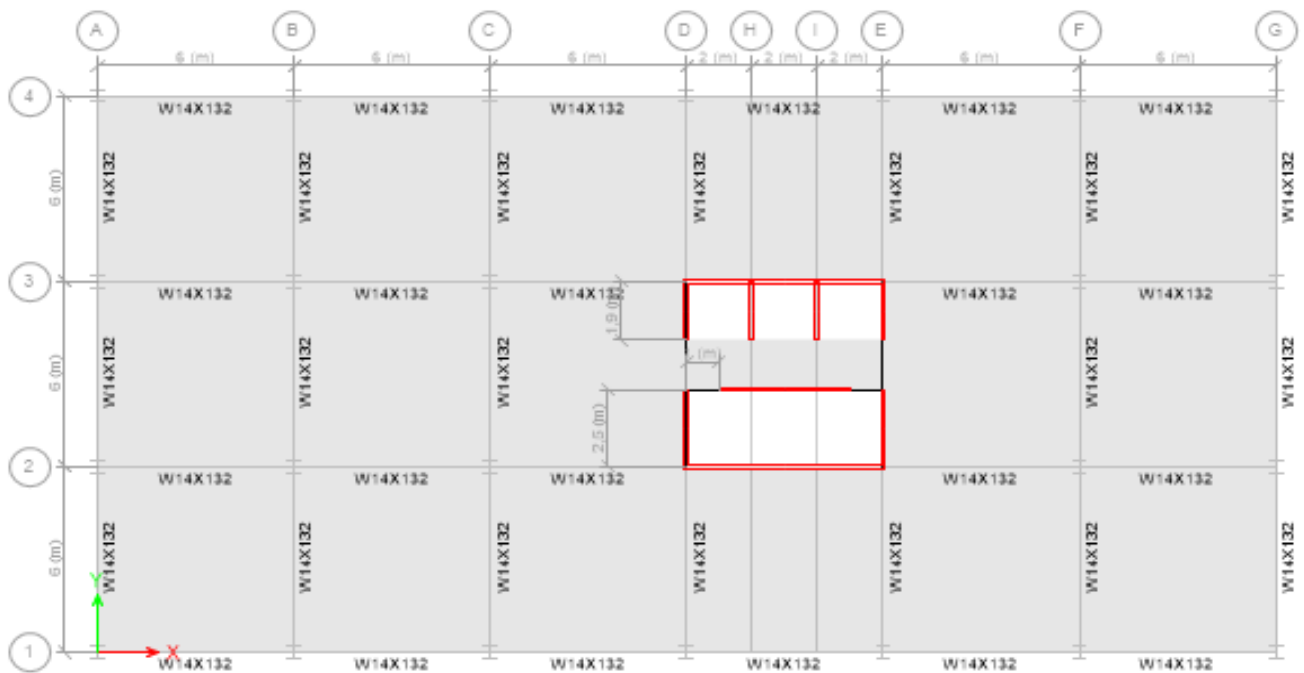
7: Vista en planta de las vigas correspondiente a los pisos 1-6, edificio tipo A.
